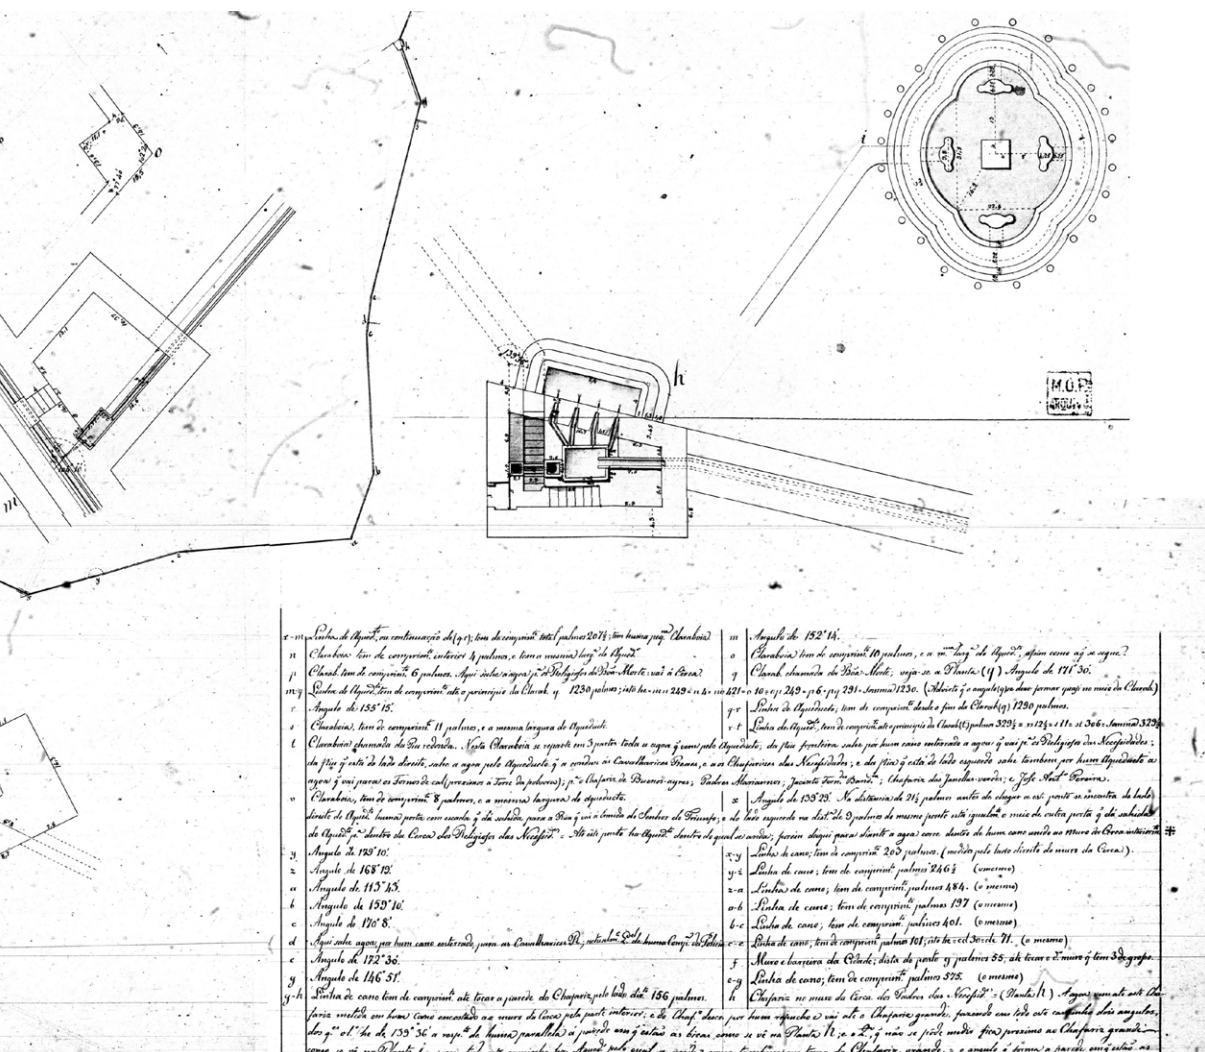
PLANTA DA GALERIA DAS NECESSIDADES
